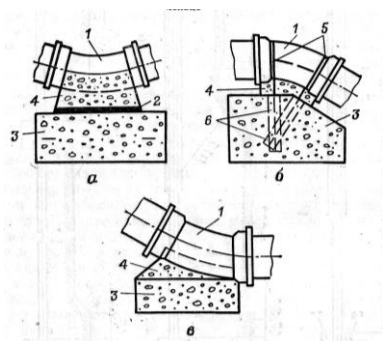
Упоры чугунных напорных трубопроводов:
